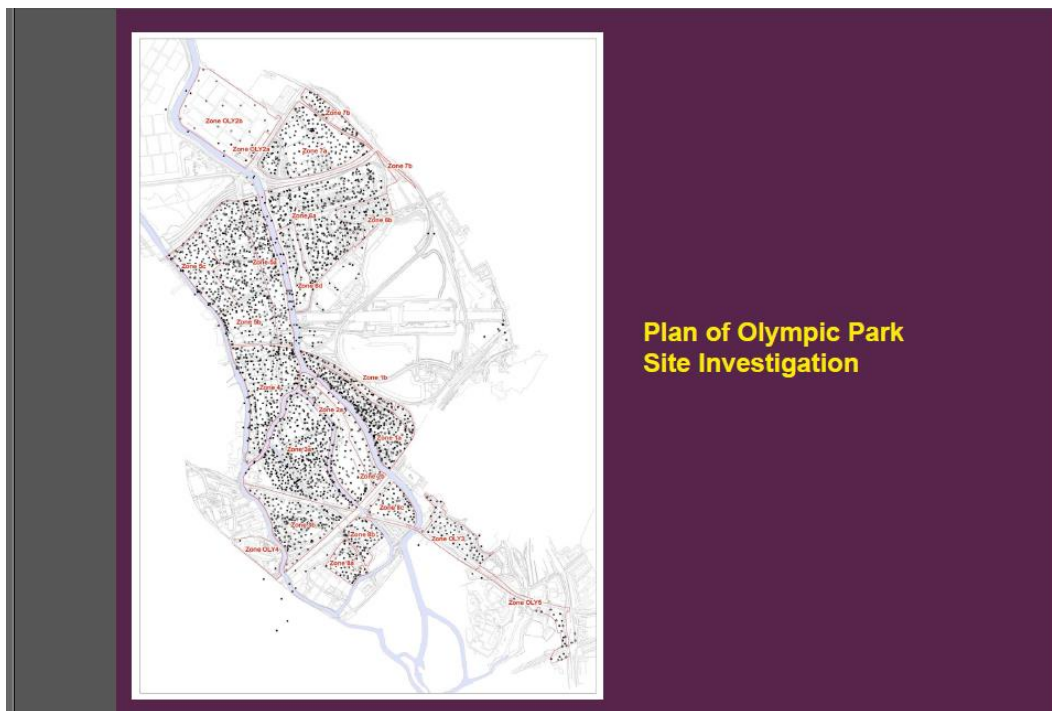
Planta do Site de investigação do projeto de remediação de áreas contaminadas, Londres.
